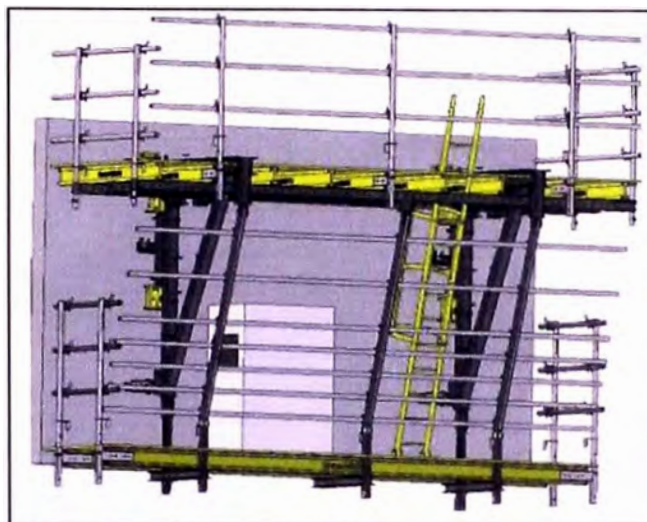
Consolas ATR MK, colgado de cajetines de anclaje
